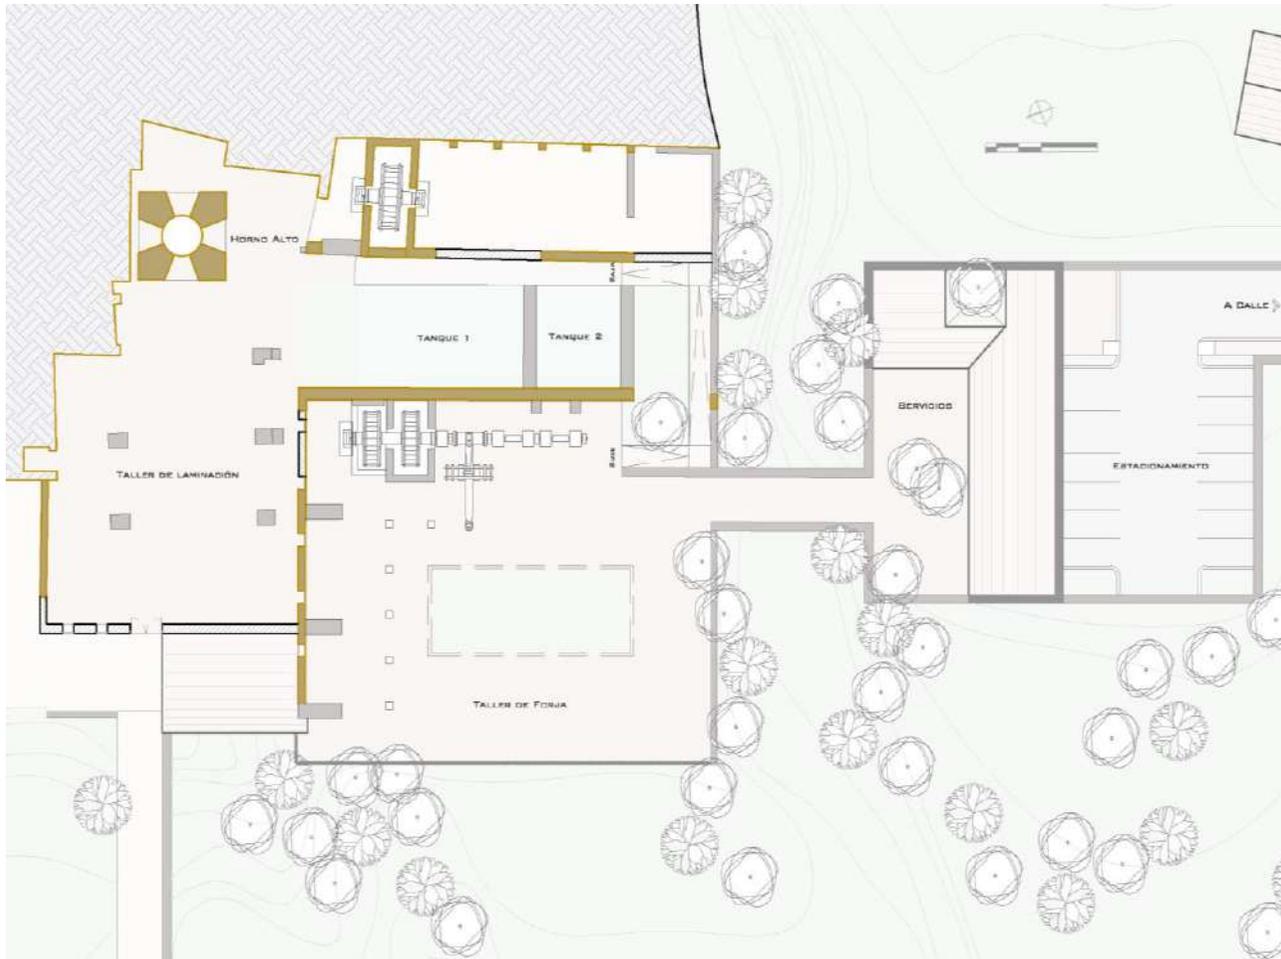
Planta de Conjunto, en amarillo se indican los muros originales.
